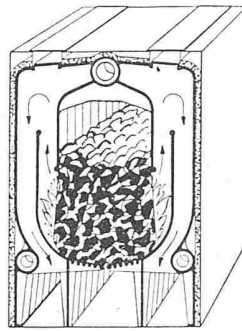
Gusseiserner Schachtkessel mit unterem Abbrand
